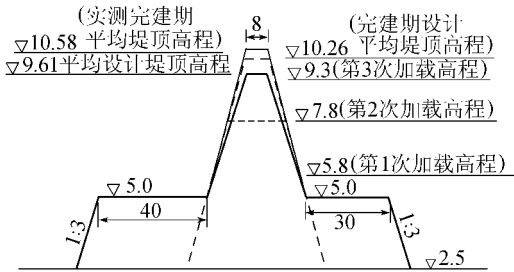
北堤设计断面、分期施工及竣工实测断面示意图(单位:m)
